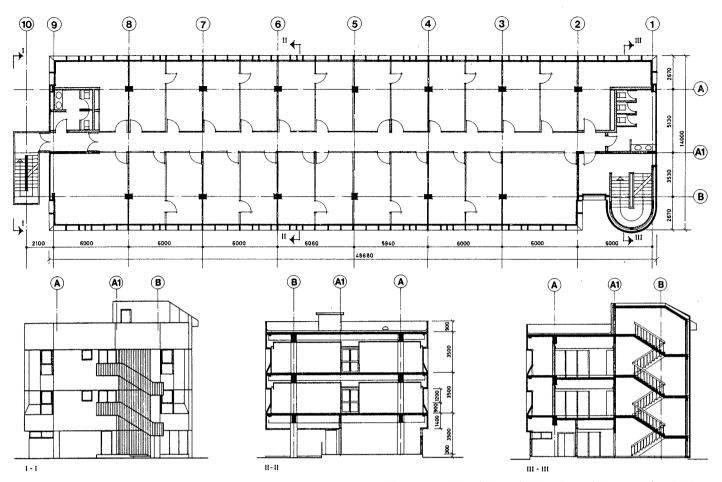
Etageplan samt tværsnit og opstalt, 1:300. BSED's ny administrationsbygning er udført som en pladestøbt betonskeletbygning med ydervægge af præfabrikerede betonelementer.
